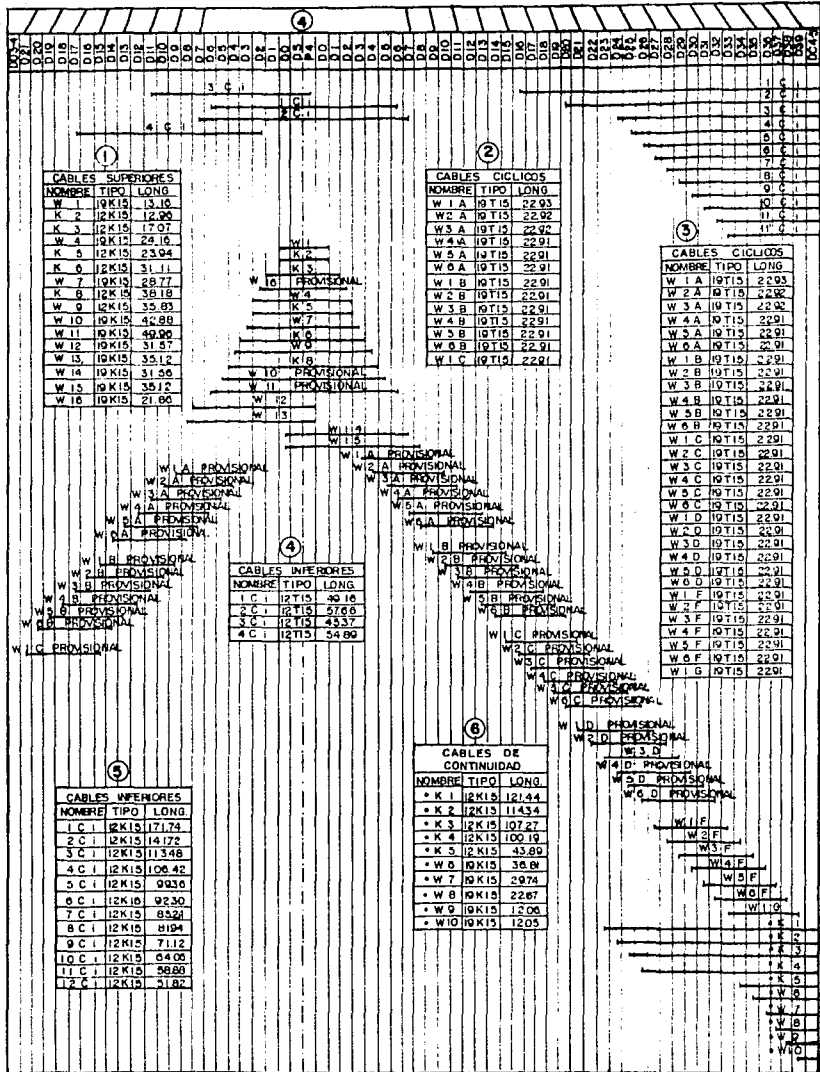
Cableado en doble voladizo. Tramo 4-5
